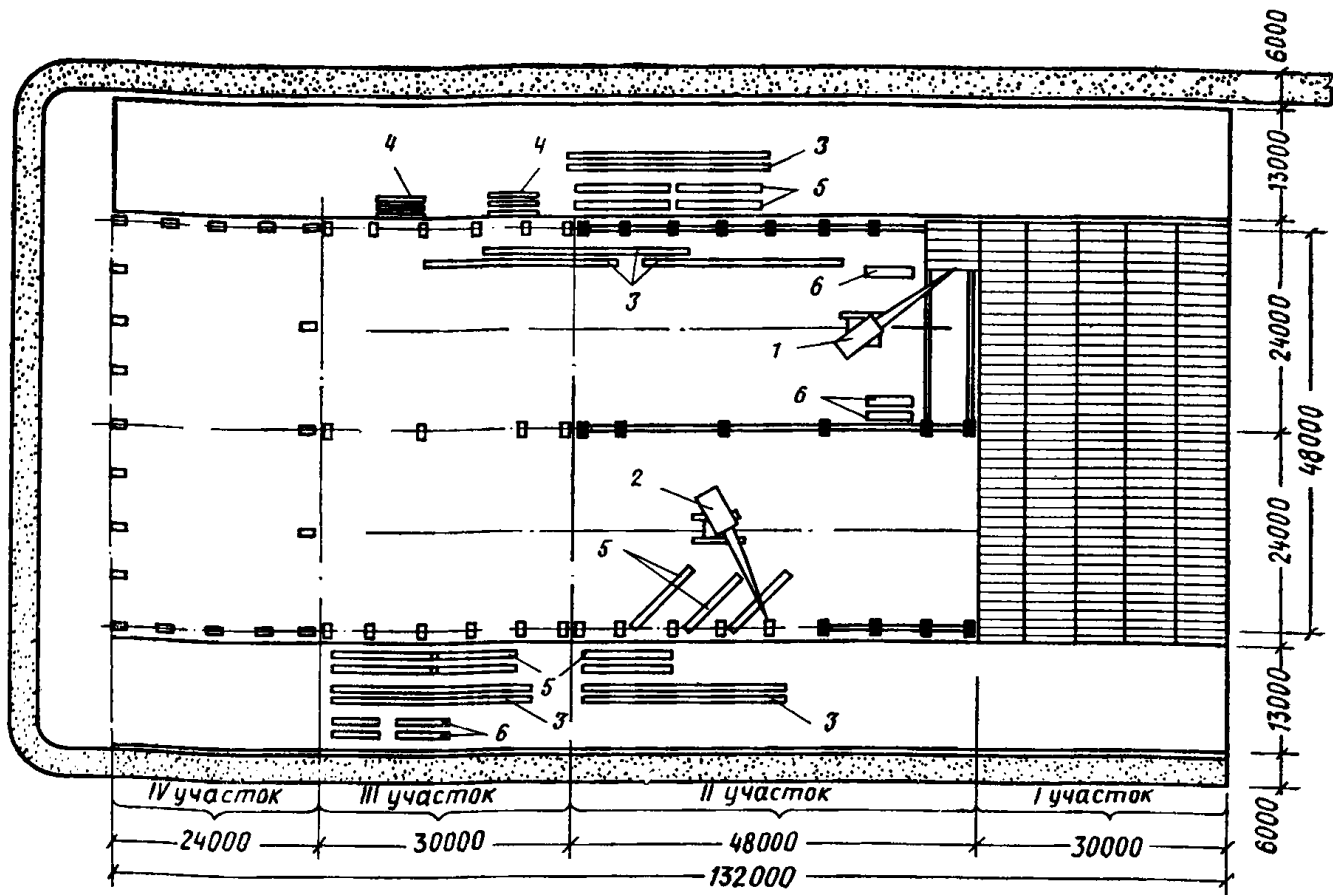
Монтаж сборных железобетонных конструкций главного корпуса обогатительной фабрики
